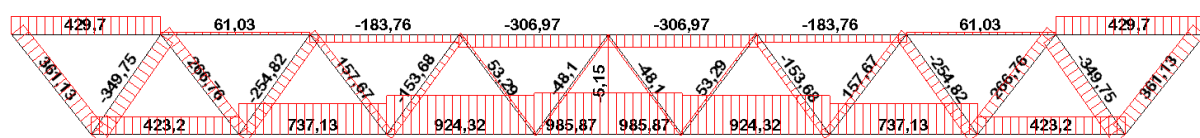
Эпюры усилий в элементах фермы от снеговой нагрузки
